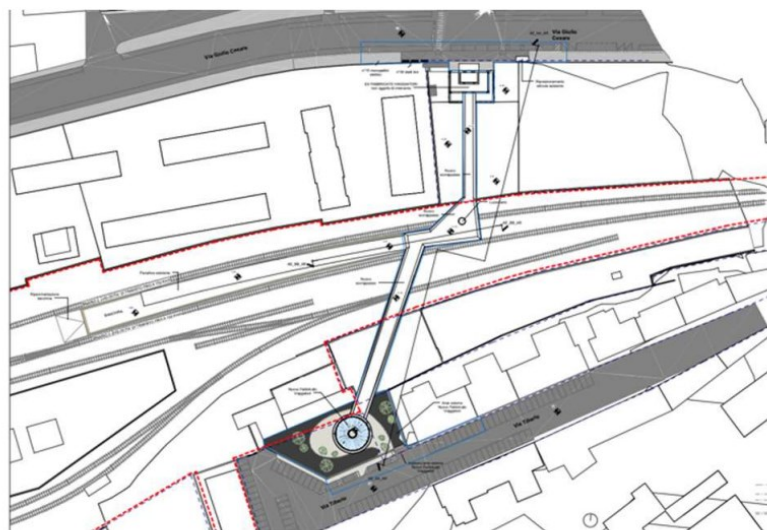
Planimetria e sezione di progetto con indicazione del collegamento tra sovrappasso e nuovo FV (Fonte: Lista di controllo)
